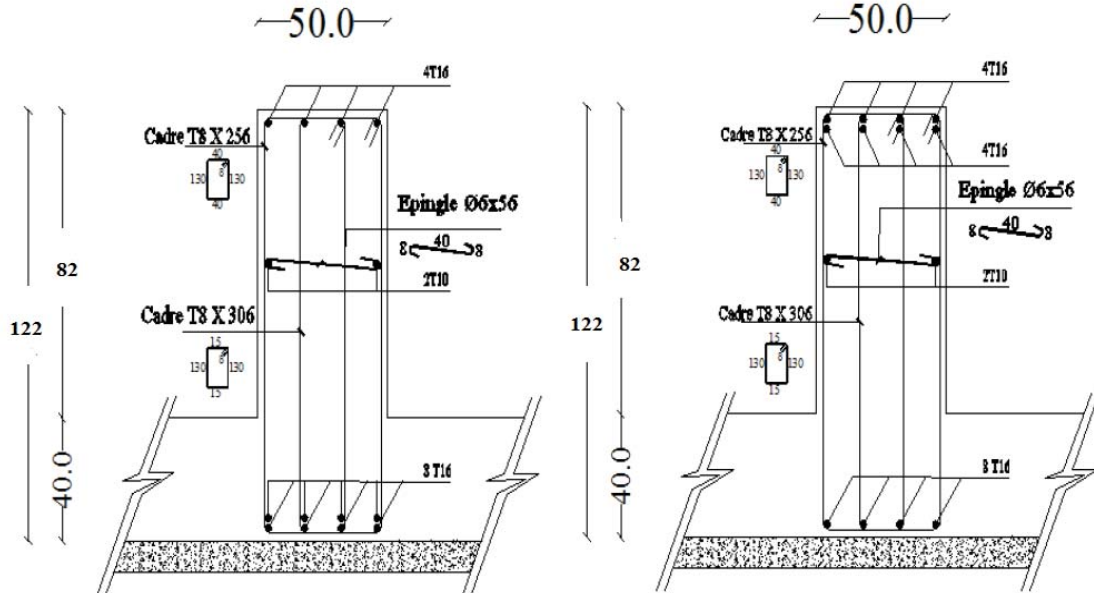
Fig XI. : Dessin de ferrailage d'une poutre secondaire.
